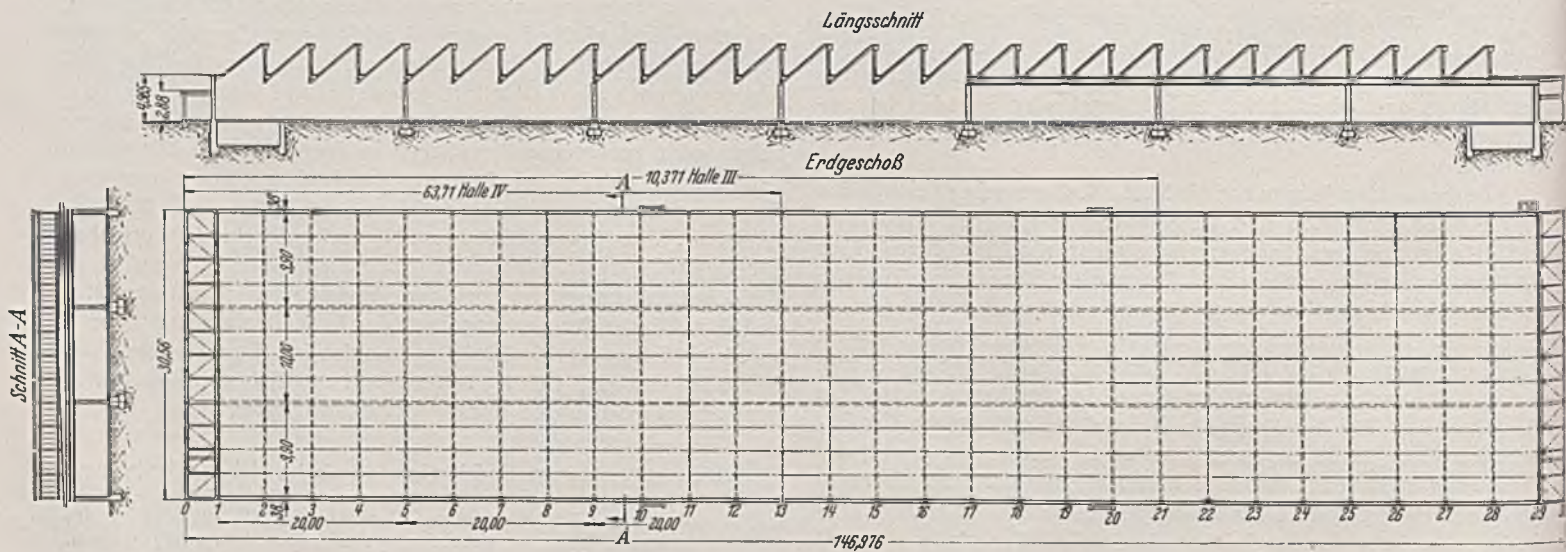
Bau I: Grundriß, Quer- und Längsschnitt.
